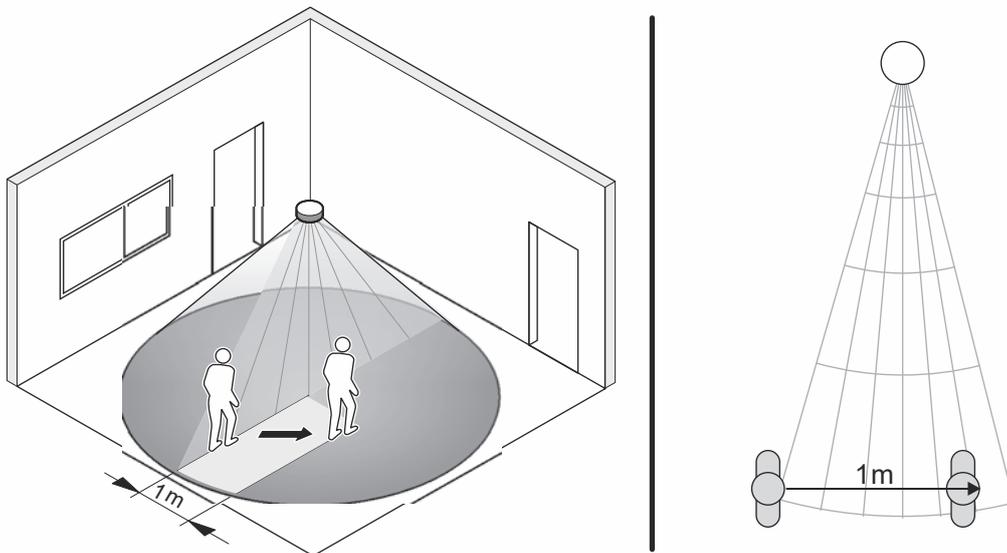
Rilevamento trasversale rispetto all'apparecchio
